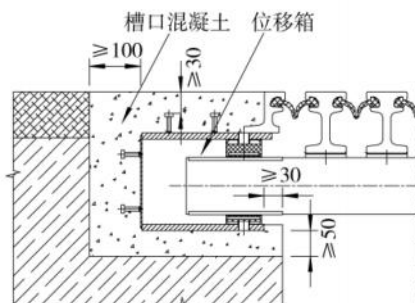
多缝伸缩装置槽口断面示意图(单位:mm)
